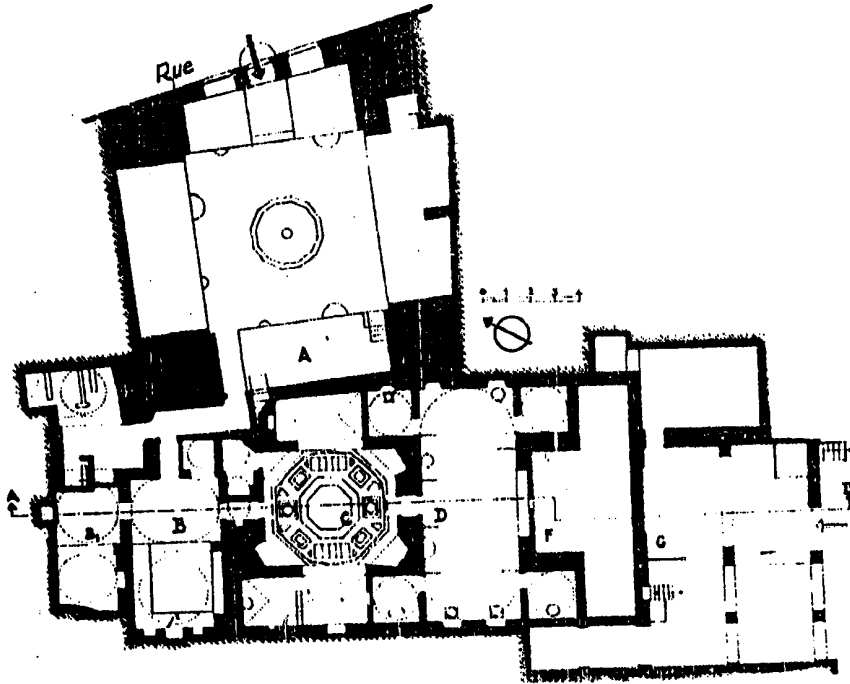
مسقط أفقي لحمام بشتاك بالقاهرة (عن المجلس الأعلى للآثار)
